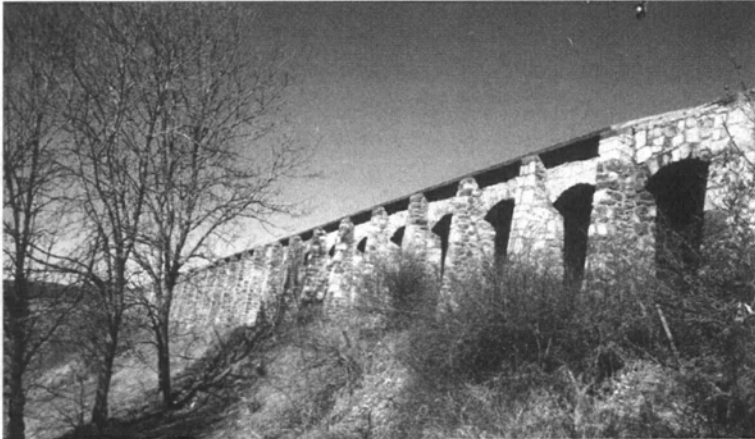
Tunnel pare-congères le long d'une voie ferrée en Lozère
